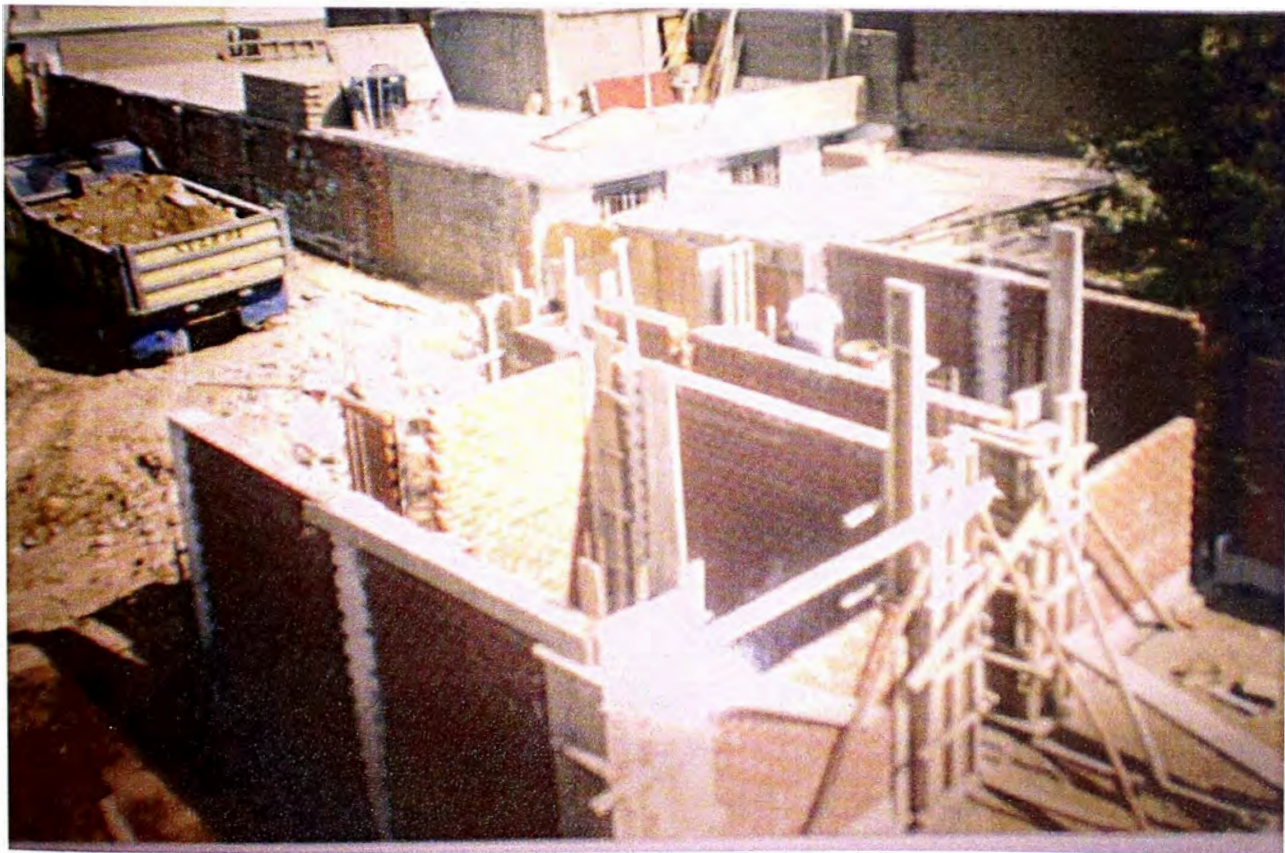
VISTA DE ENCOFRADO DE VIGAS EN S.S.HH.
